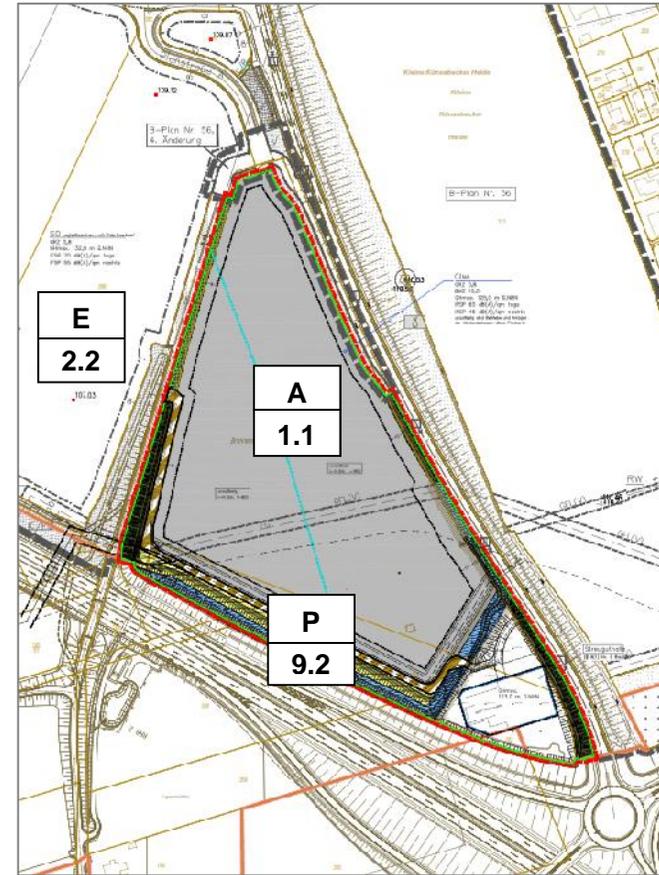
Darstellung im Bebauungsplan Nr. 56 und im Bereich der 5. Änderung
